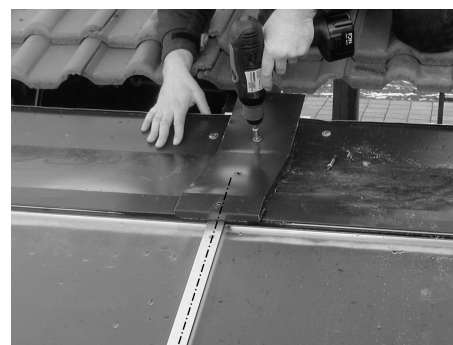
Posizionare, allineare ed avvitare la seconda lamiera superiore ed il collegamento
